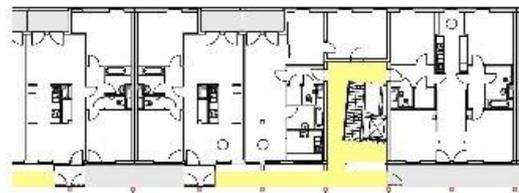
Loggien und Laubengänge im Bauteil Arch. Podreka
